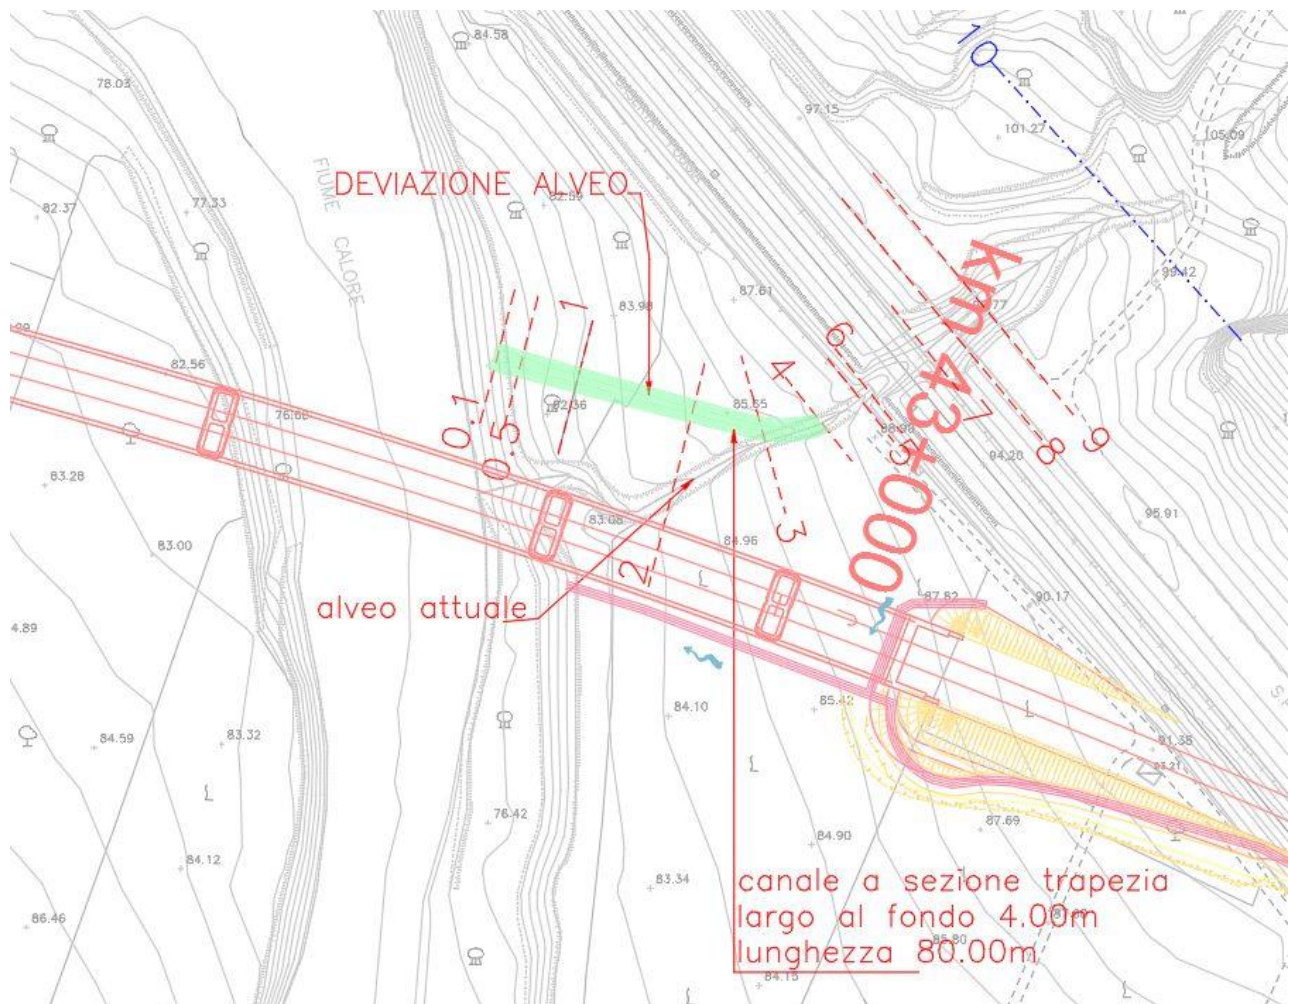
Stralcio planimetria di progetto del Fosso a progr. 42+980
